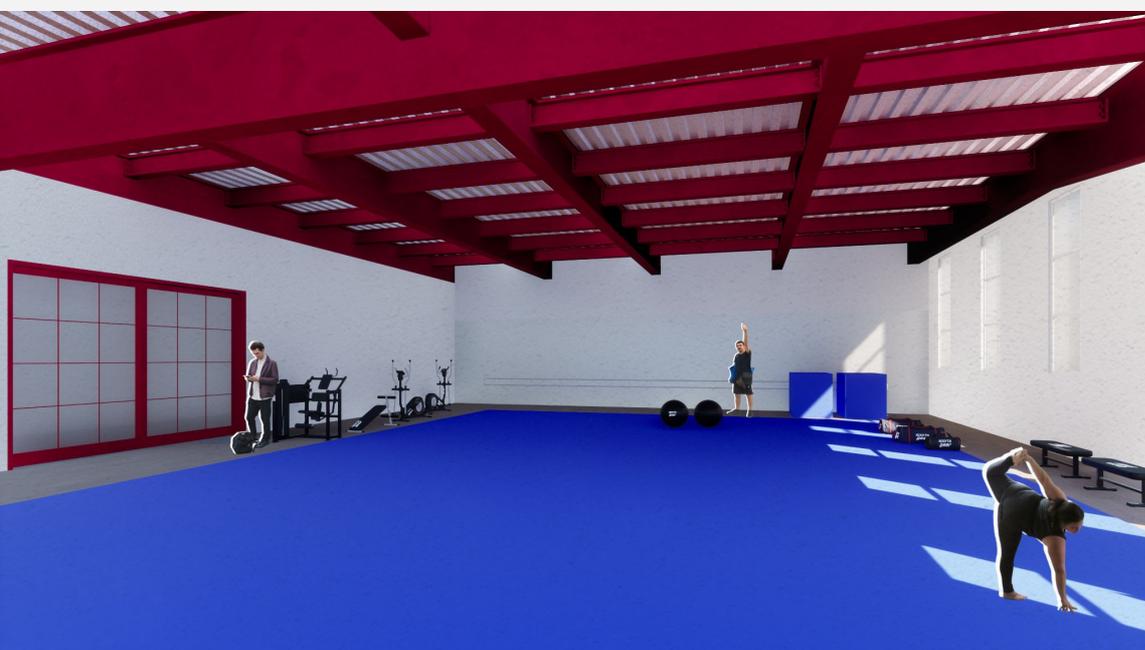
Render de projeto. Sala de artes marciais no primeiro pavimento do edifício principal. Fonte: Elaboração própria
